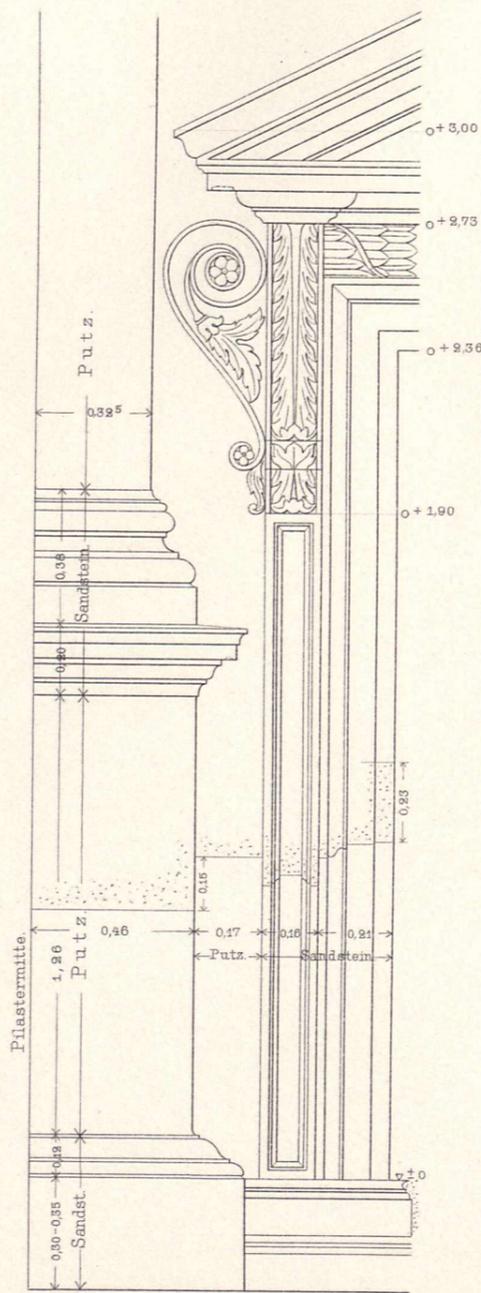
Pilastersockel, Gebäudesockel und Portalgewände.
